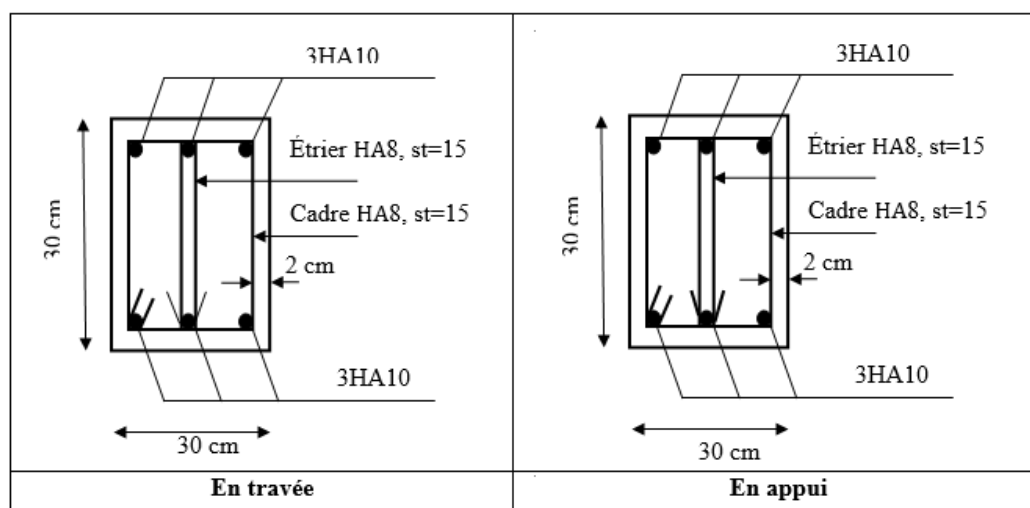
Schéma de ferrailage de la poutre de chaînage
